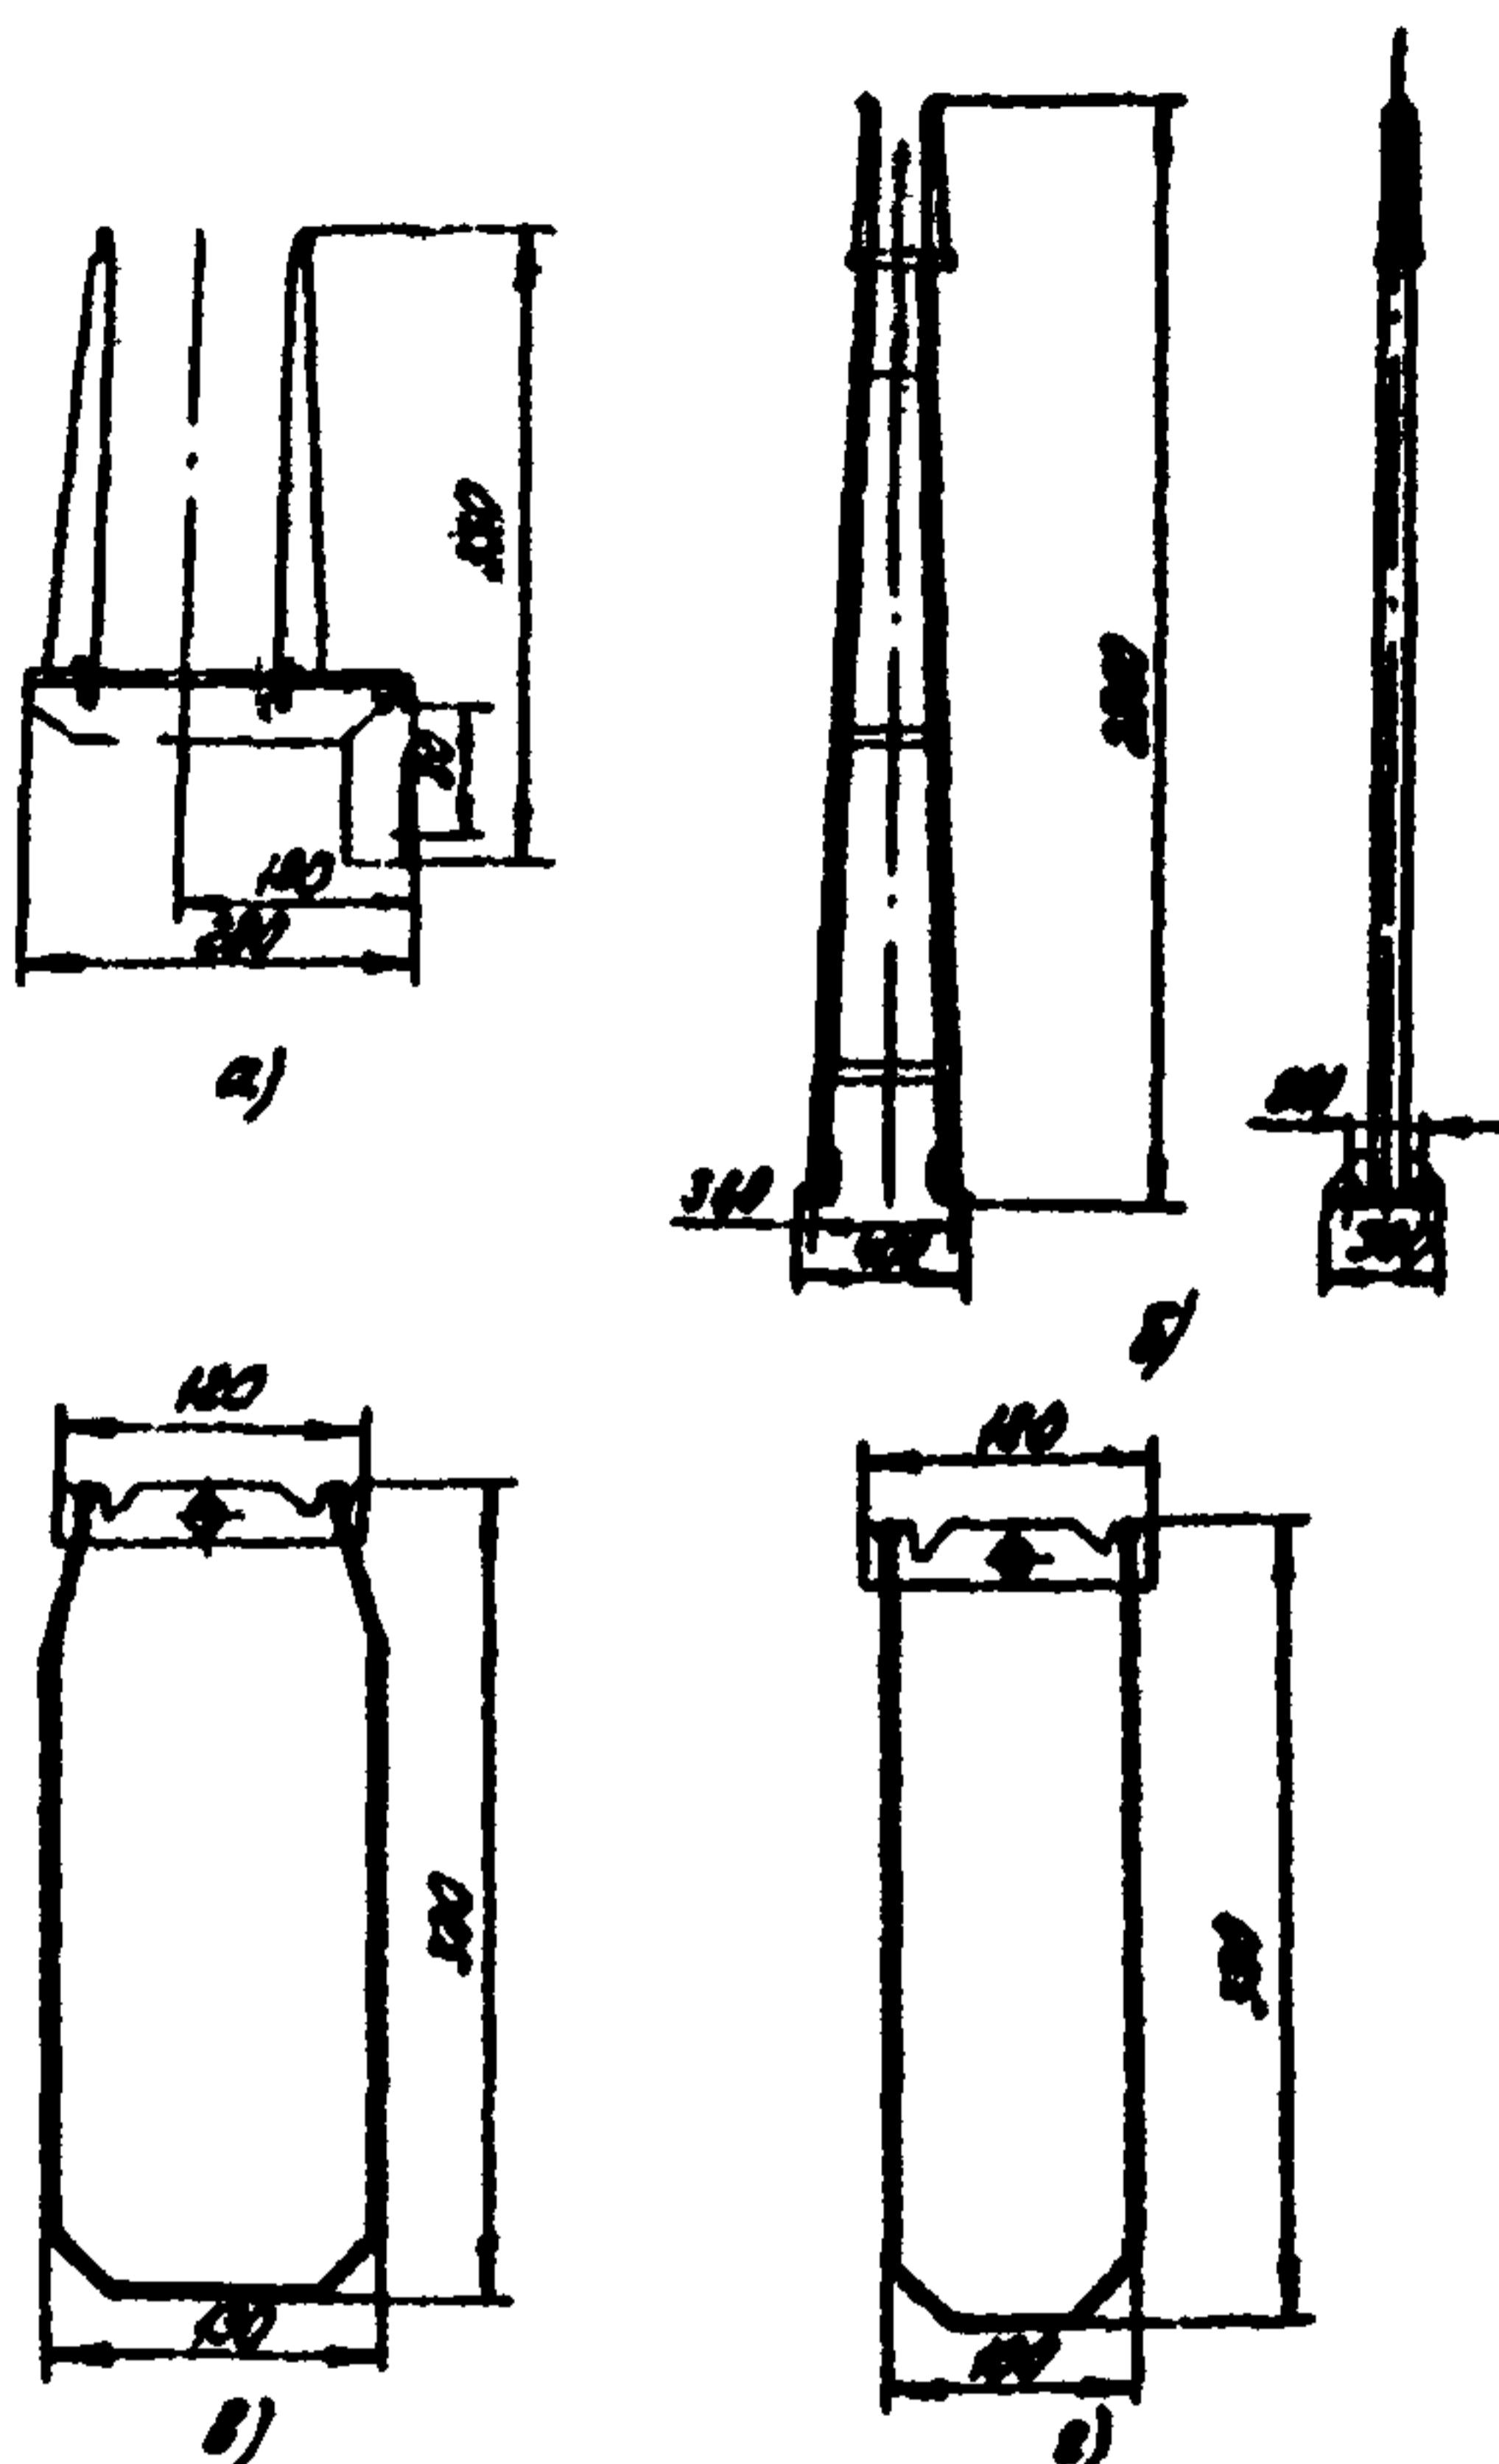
Конструкции для крепления шинопроводов: а - кронштейн У2081; б - стойка У2084; в - подвес У2080М2 (для ШРА4 на 630 А); г - подвес У2080М1 (ШРА4 на 250 и 400 А).
